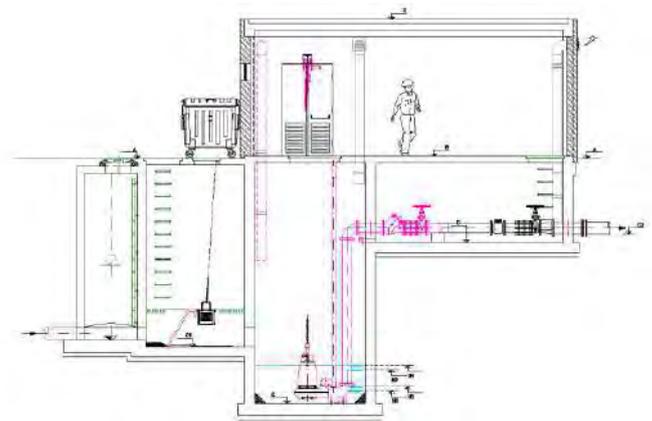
Corte esquemático das estações elevatórias do Tipo 2.
